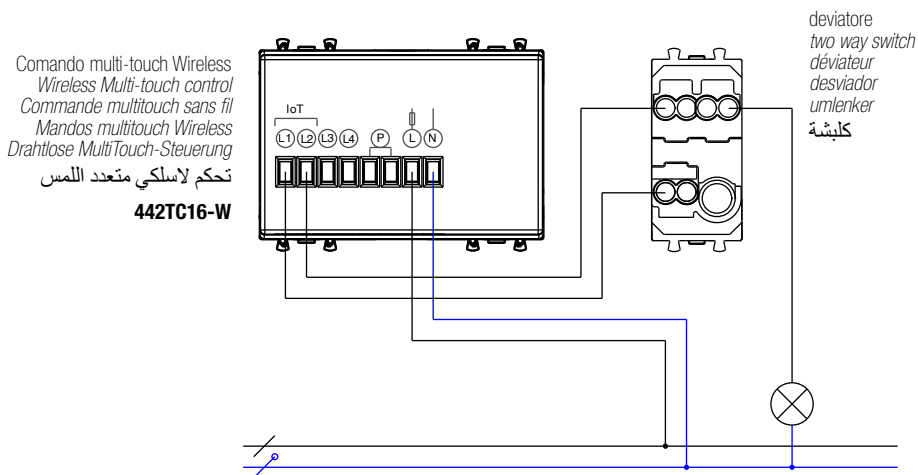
Schema di collegamento - Connection diagram - Schéma de connexion - Esquema de conexión - Anschlusschema - مخطط التركيب
